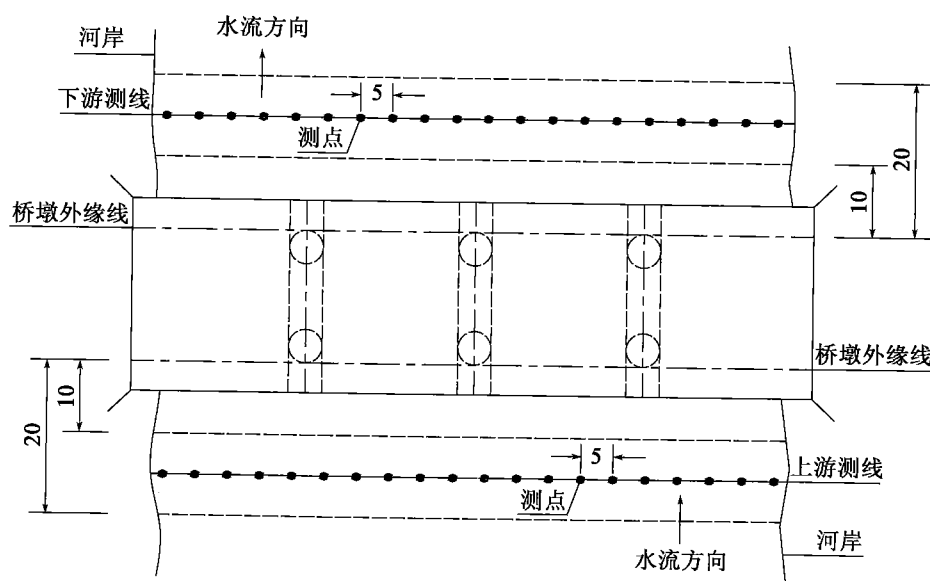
河床断面测线布置示意图(尺寸单位:m)
